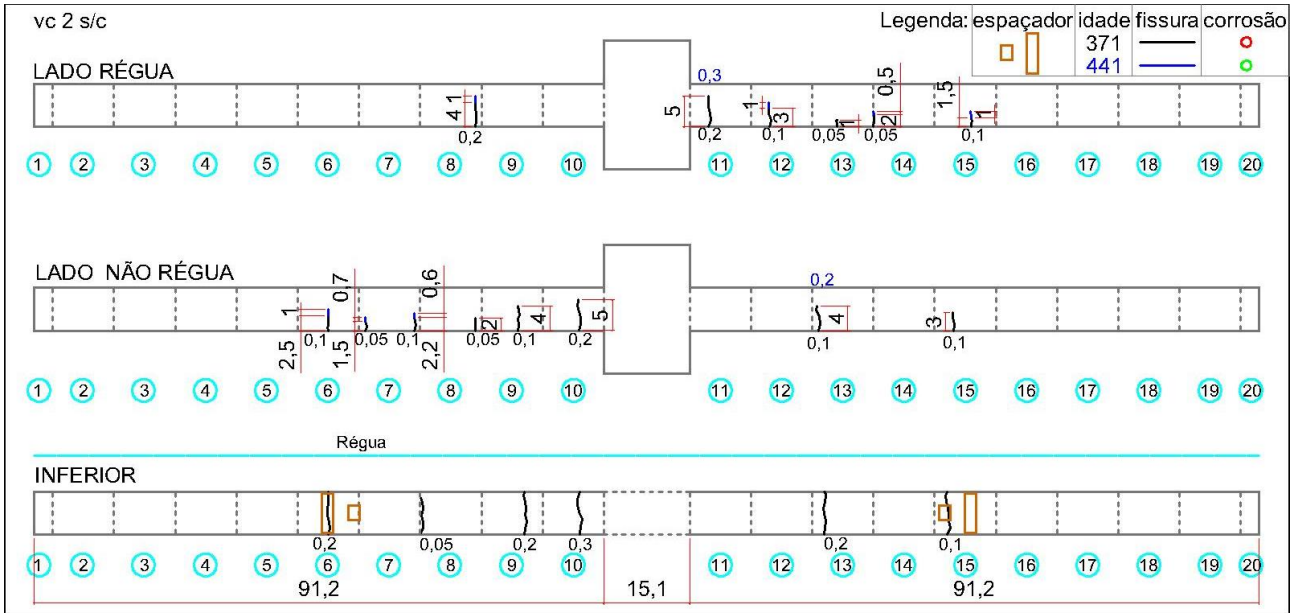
Mapa das fissuras na viga vc 2 s/c
